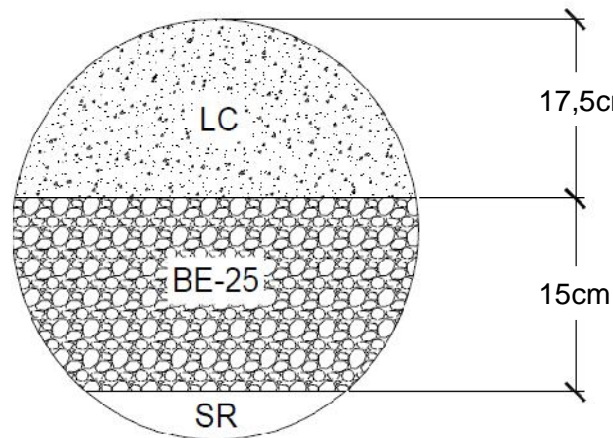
Estructura propuesta para calle de acceso a Sede de Occidente, periodo de diseño de 10 años en opción de pavimento rígido.
